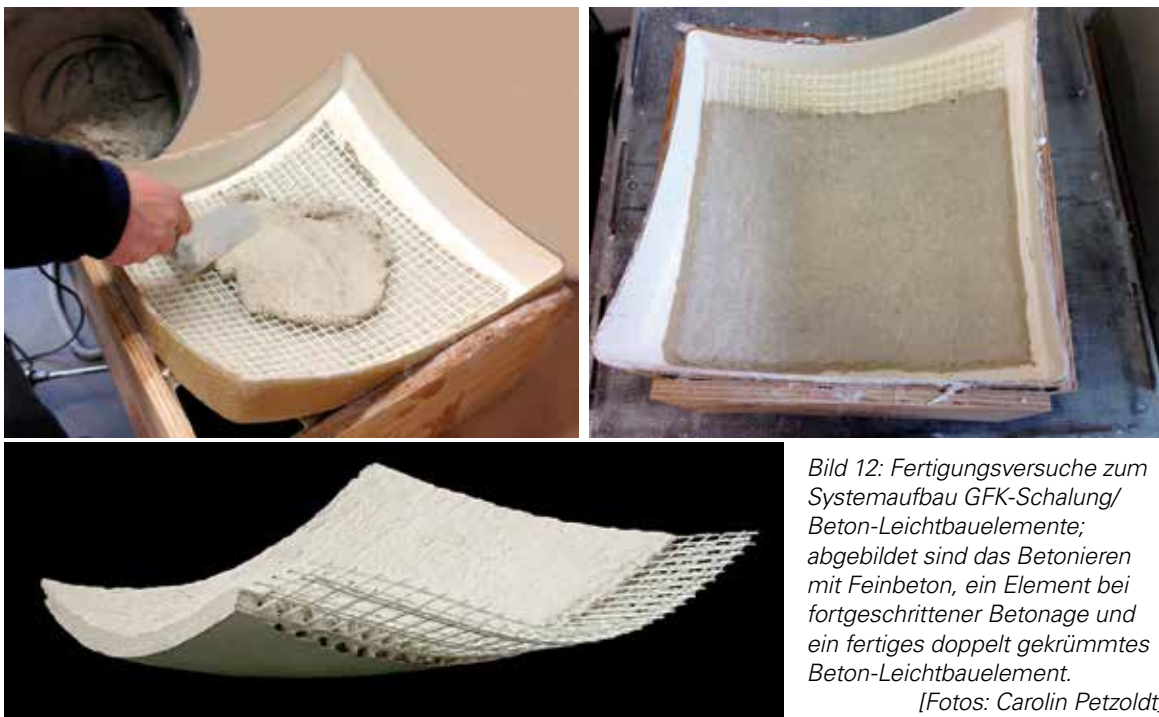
Fertigungsversuche zum Systemaufbau GFK-Schalung/Beton-Leichtbauelemente; abgebildet sind das Betonieren mit Feinbeton, ein Element bei fortgeschrittener Betonage und ein fertiges doppelt gekrümmtes Beton-Leichtbauelement.
